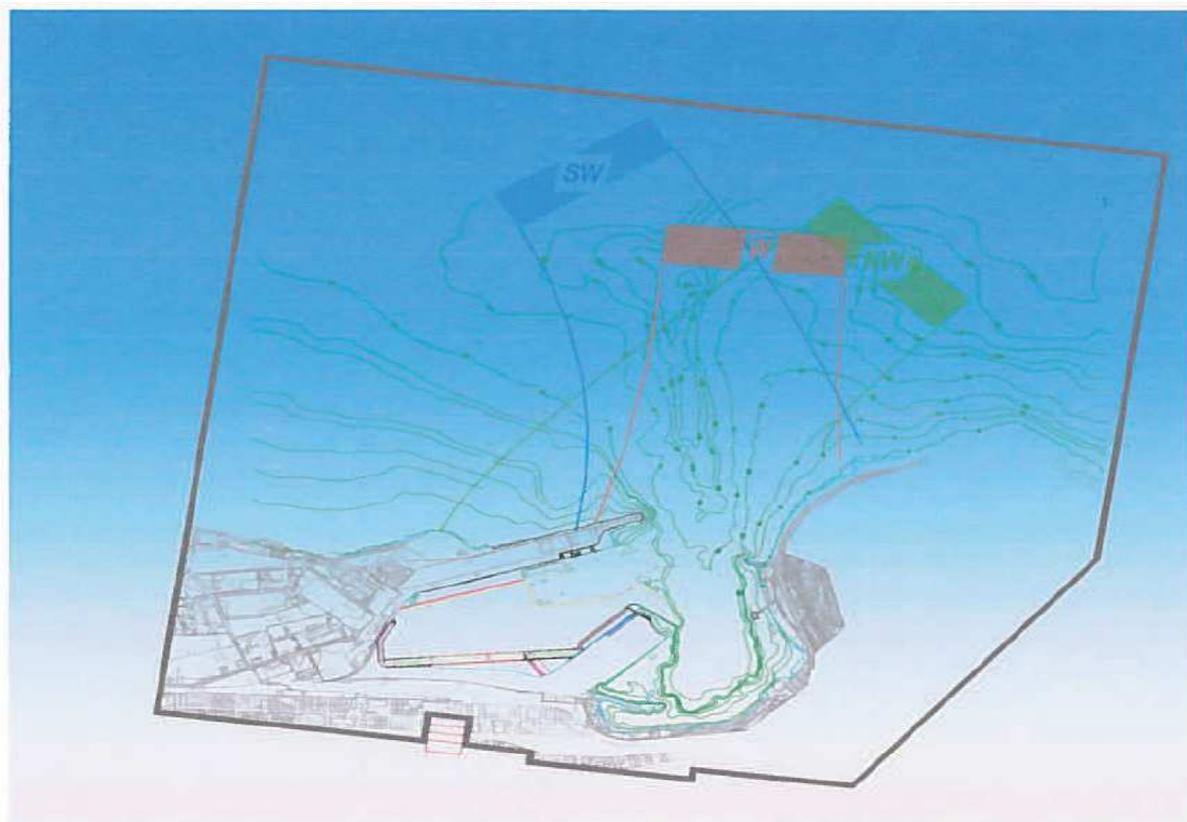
Planta General modelo físico 3D Puerto San Antonio Escala 1:125
